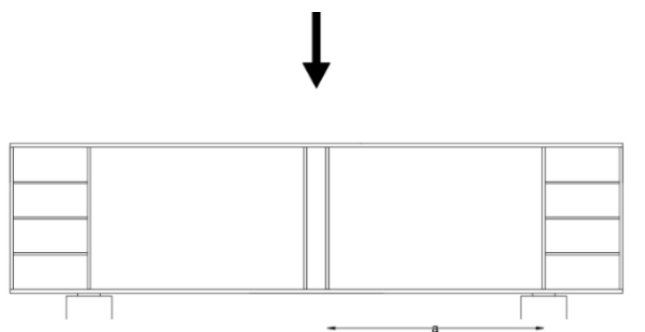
Configuração típica das vigas do Ensaio 3
